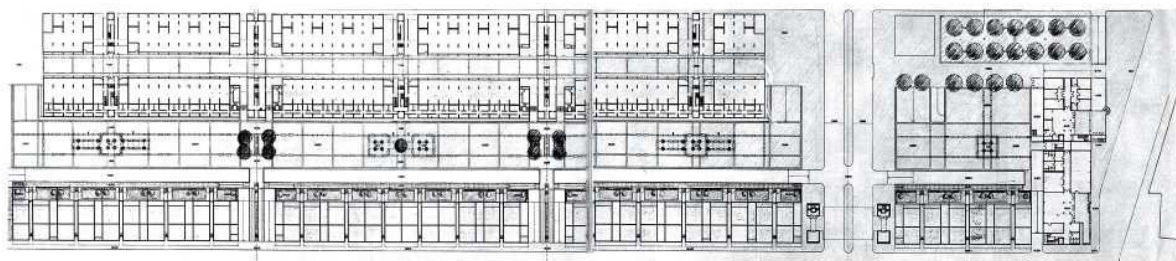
Planimetria generale di progetto del quartiere Taverna del Ferro
